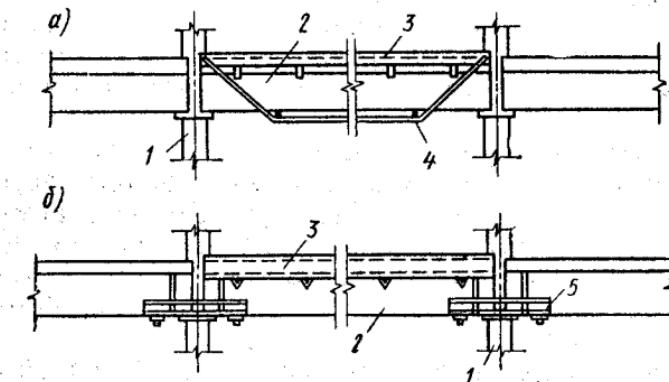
Усиление подкрановой балки шпренгелем (а) и выносными опорами (б):
